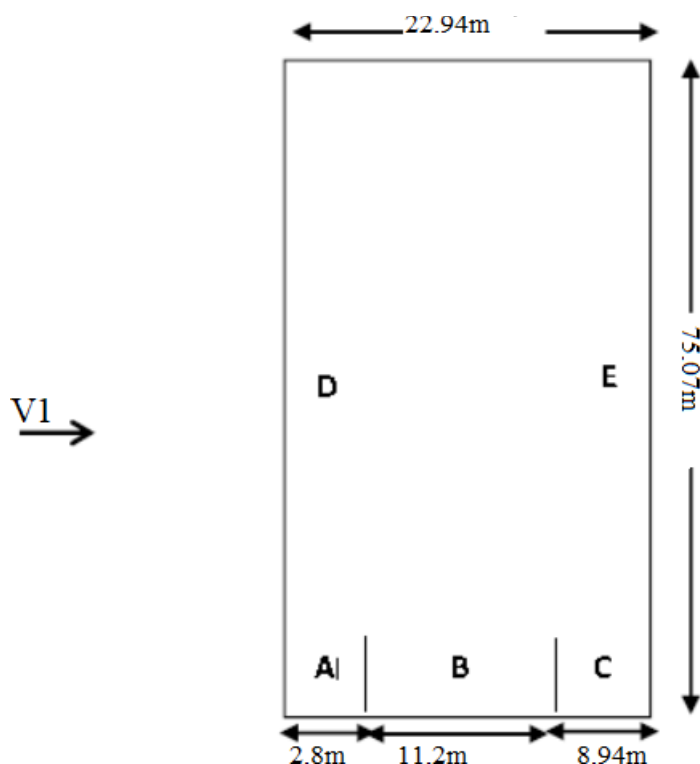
vue en plan des zones de pression sur les parois verticales sens V1.
